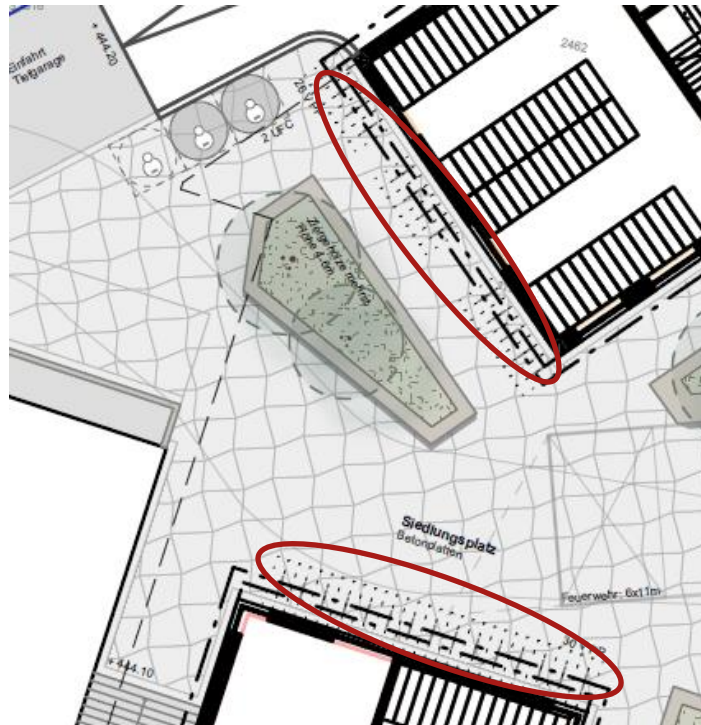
Auszüge Umgebungsplan mit Lage der oberirdischen Veloabstellplätzen
